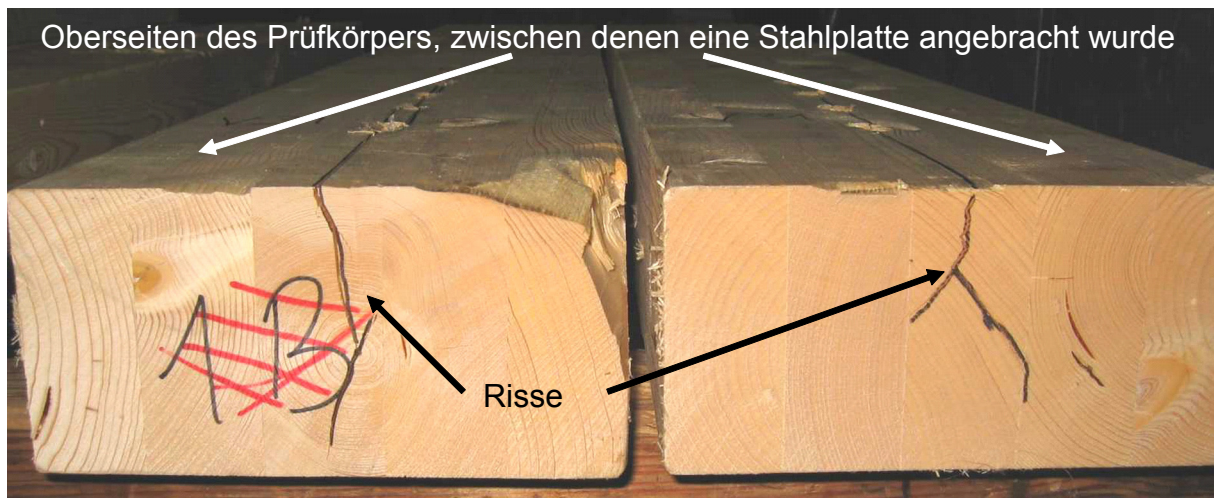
Beanspruchtes Trägerende einer verstärkten Verbindung (offener Zug-scherkörper) mit Rissausbildung
